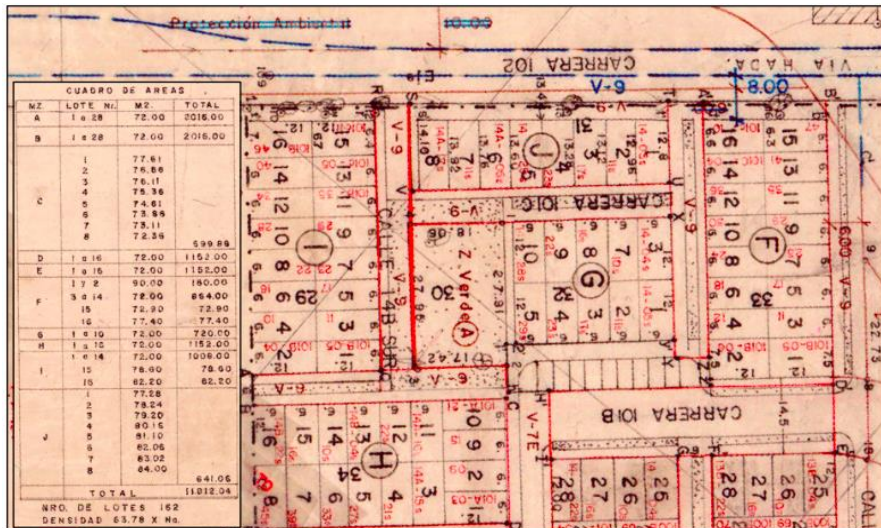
/4-00 – Desarrollo Tocarema
